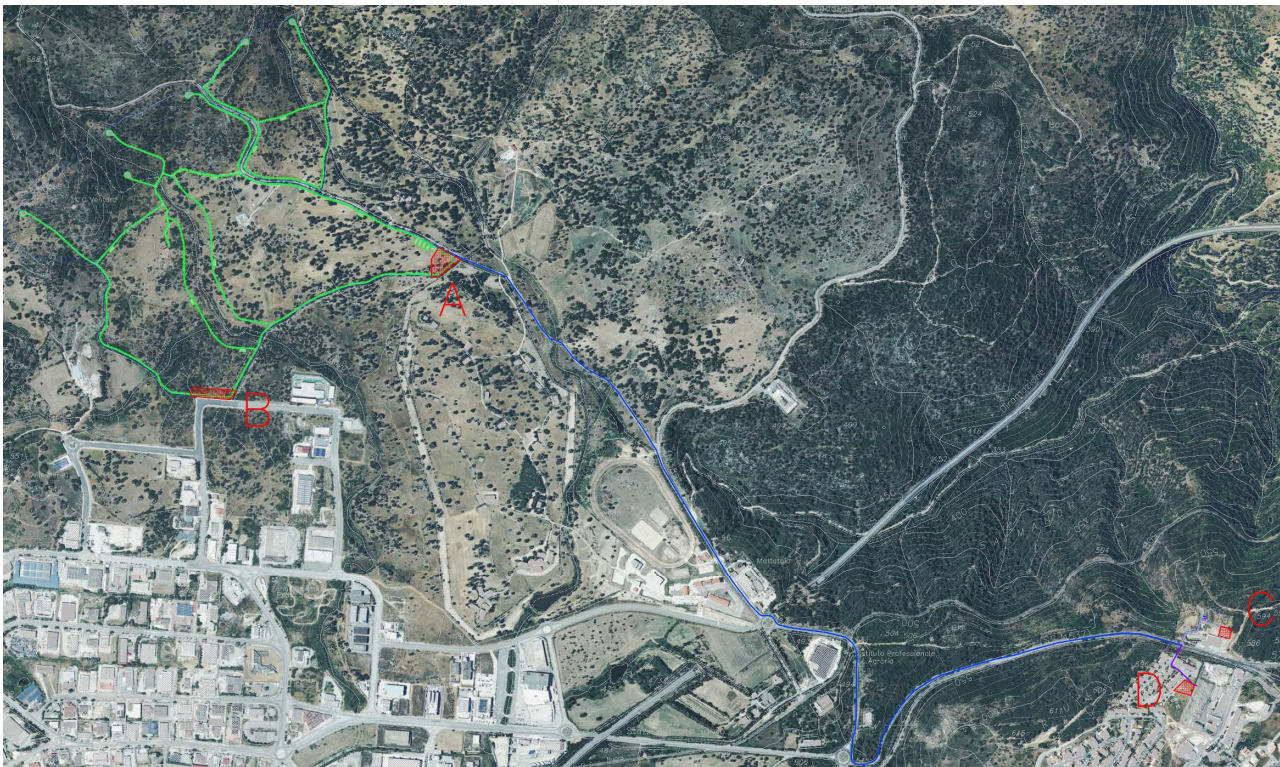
Planimetria delle aree di cantiere A, B, C, D.
